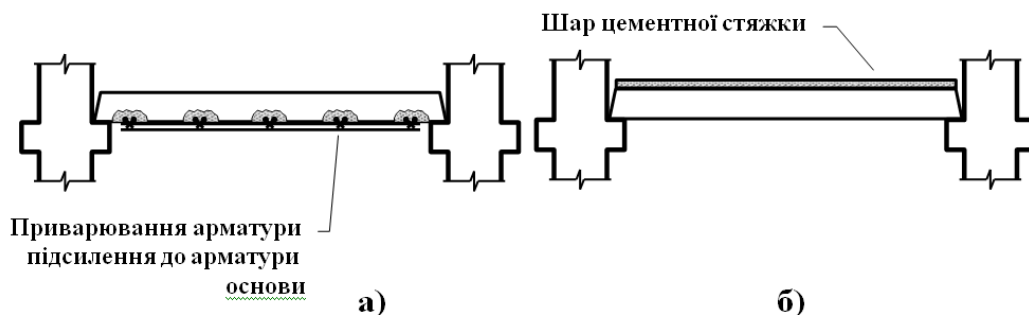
Підсилення залізобетонних плит нарощуванням перетину:
